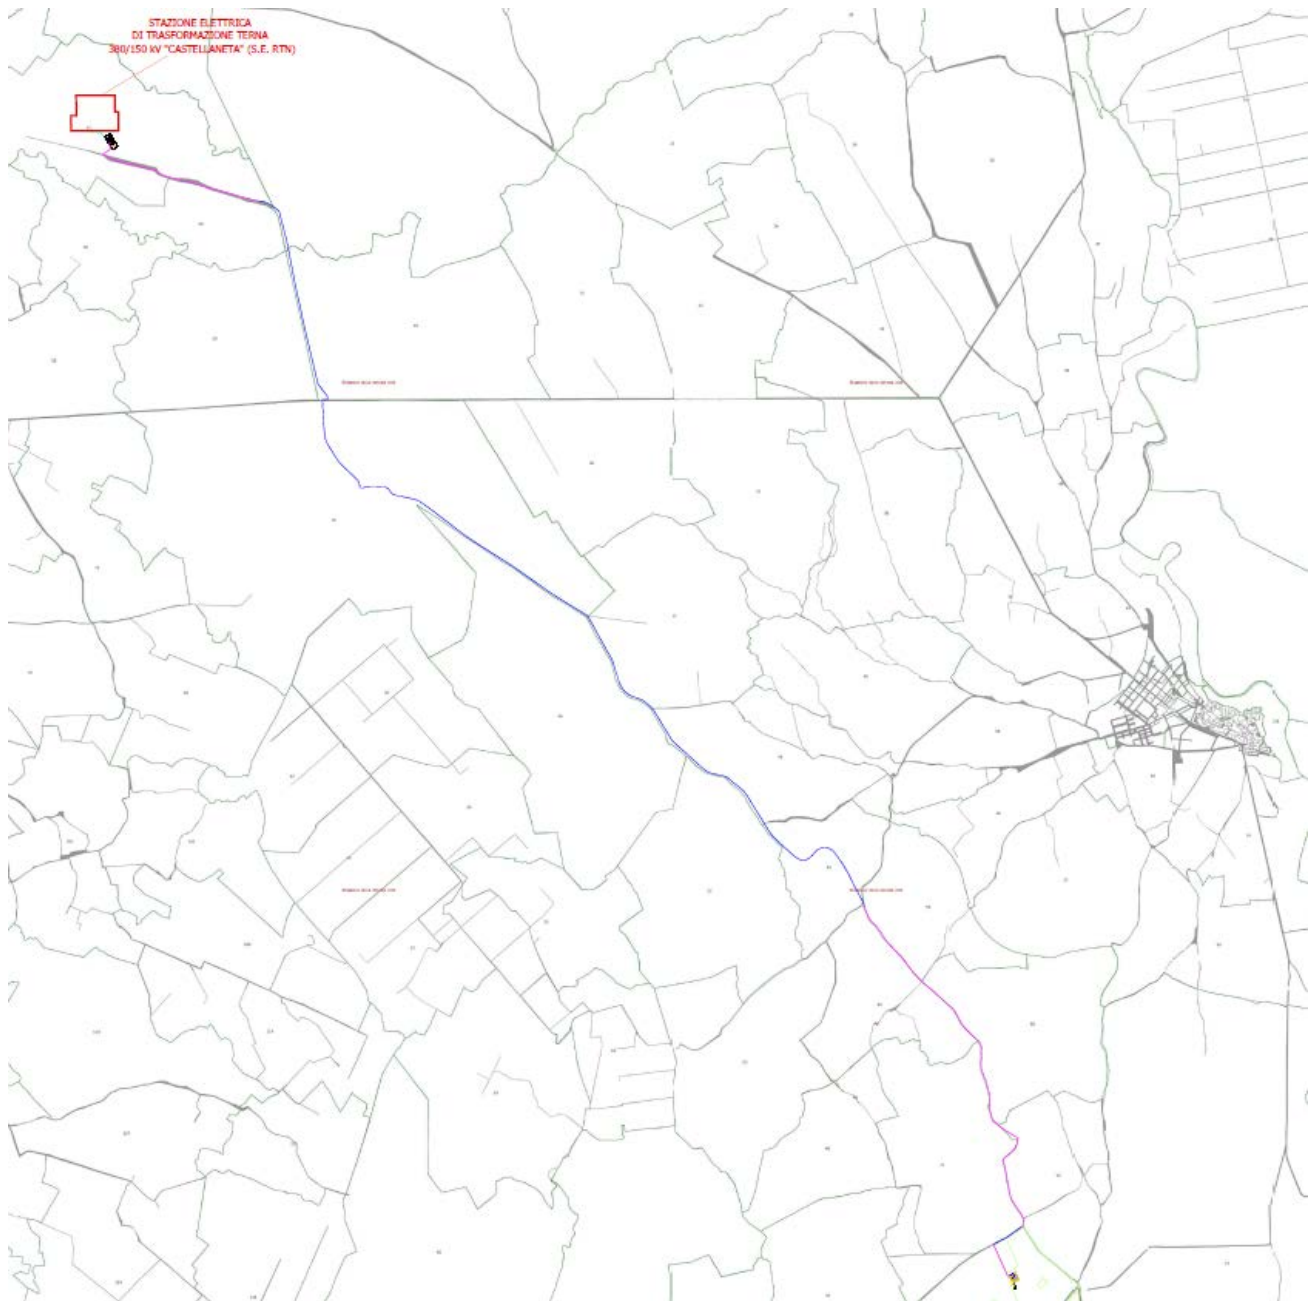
Collegamento in cavo AT su ortofoto tra SSEU ed SSM
